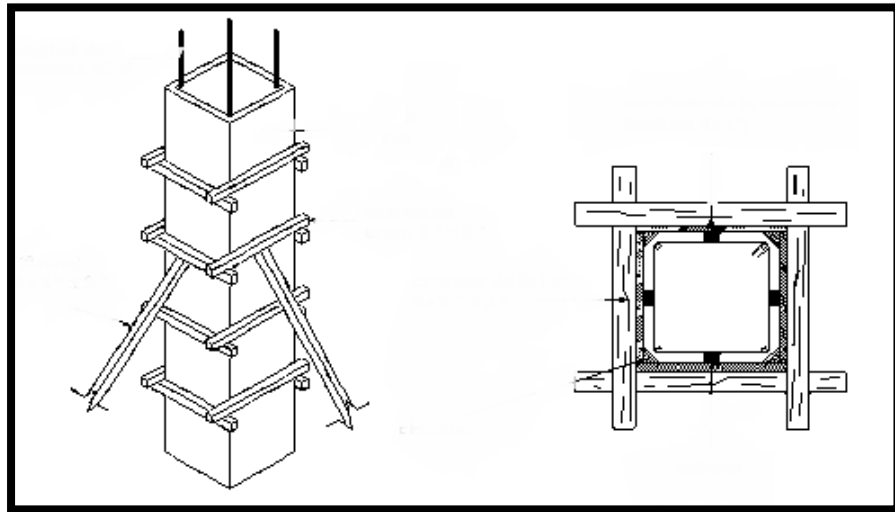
Encofrado de madera para columnas de concreto reforzado
